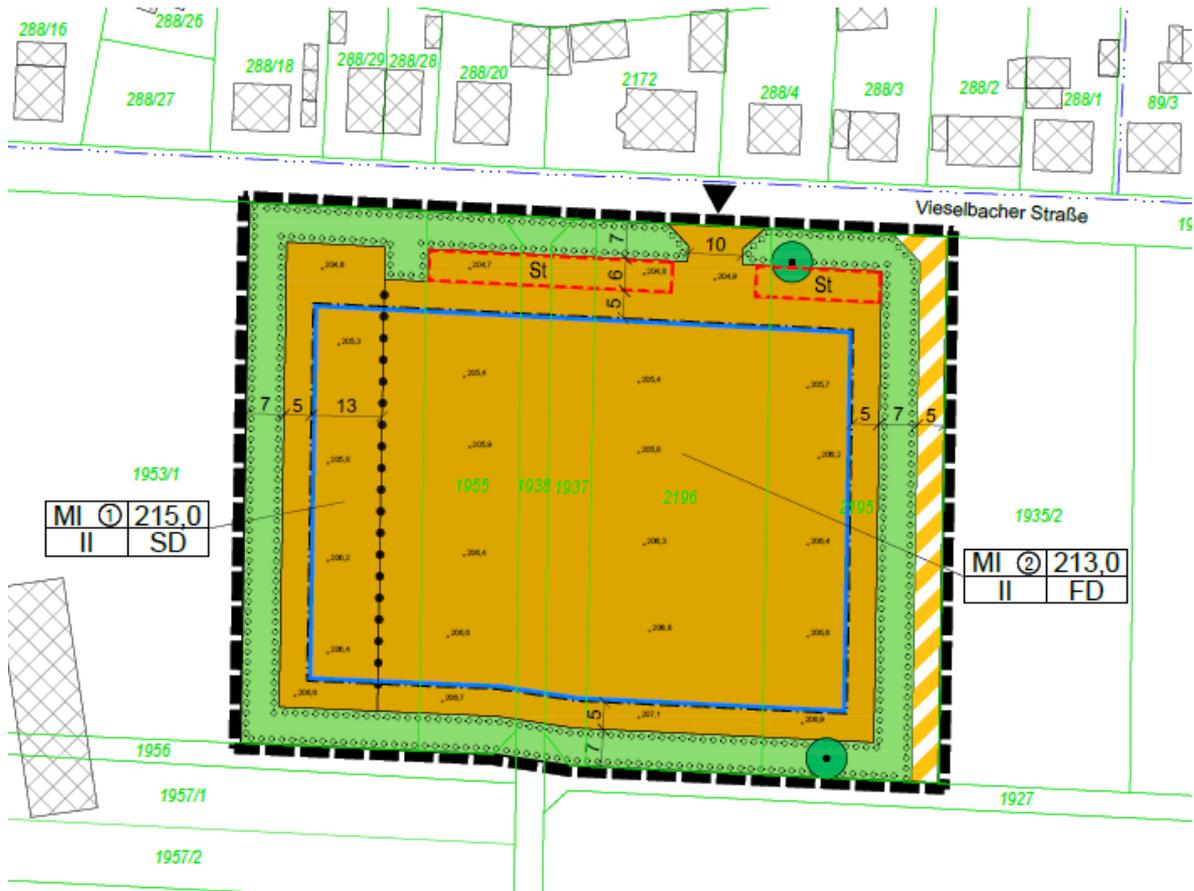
Bebauungsplan Vorentwurf Stand September 2024 | Quelle: LEG Thüringen, Kartengrundlage ThüringenViewer
